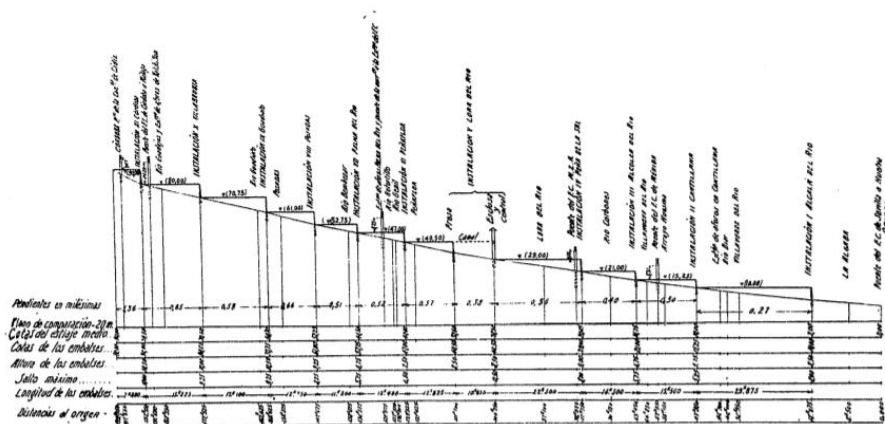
Perfil longitudinal de la canalización y aprovechamiento de energía del río Guadalquivir entre Córdoba y Sevilla (Mendoza, 1926).
